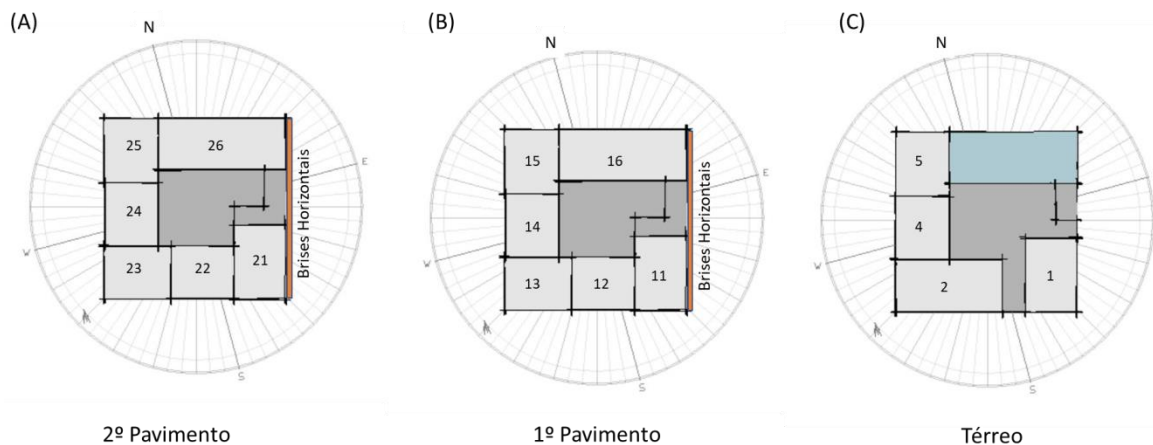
Identificação das Salas que serão objeto de estudo - (A) Nomenclatura das salas do 2º Pavimento, (B) Nomenclatura das salas do 1º Pavimento, (C) Nomenclatura das salas Pavimento Térreo.
